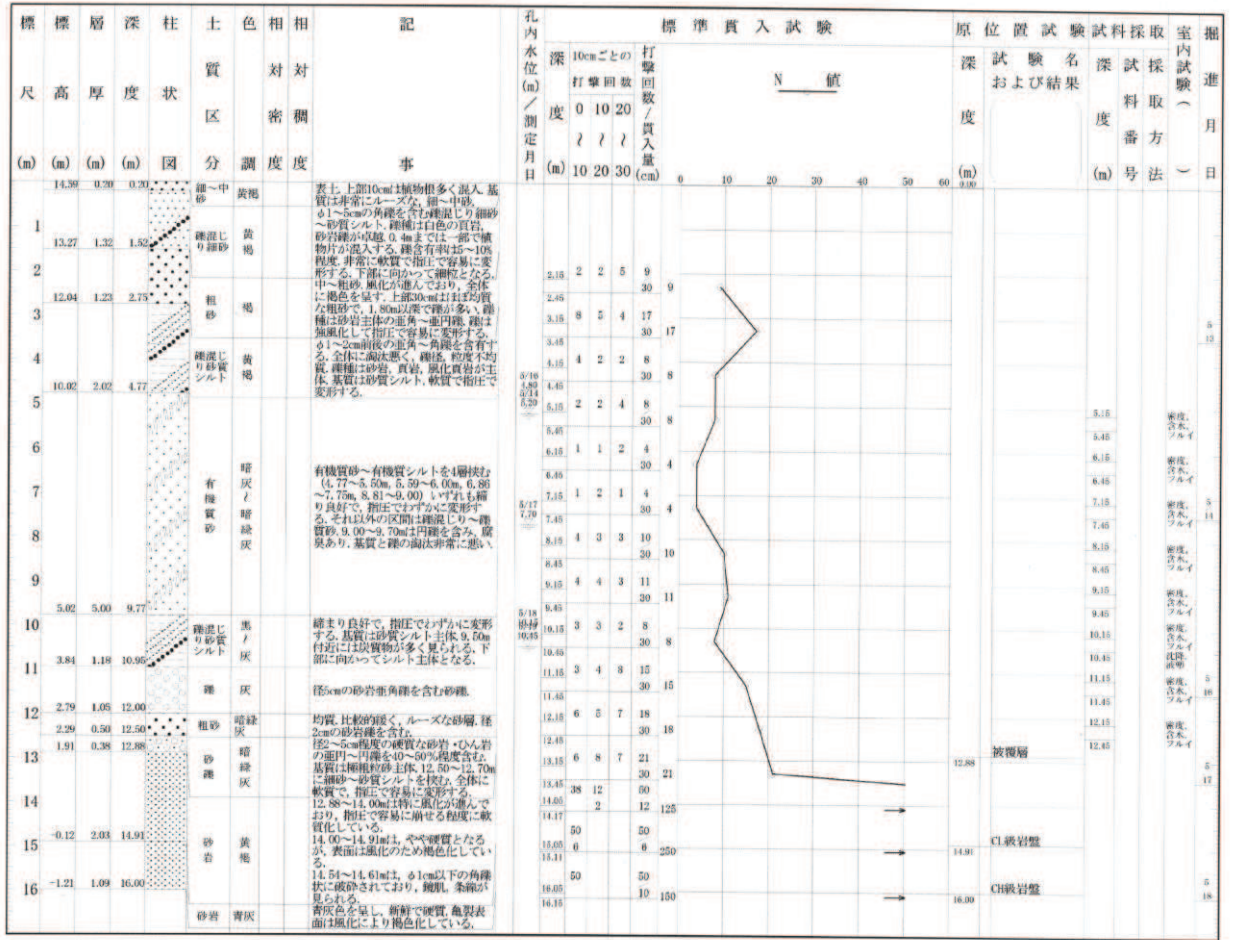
(1) ボーリング柱状図 (H23B-1) (深度0~16m)
